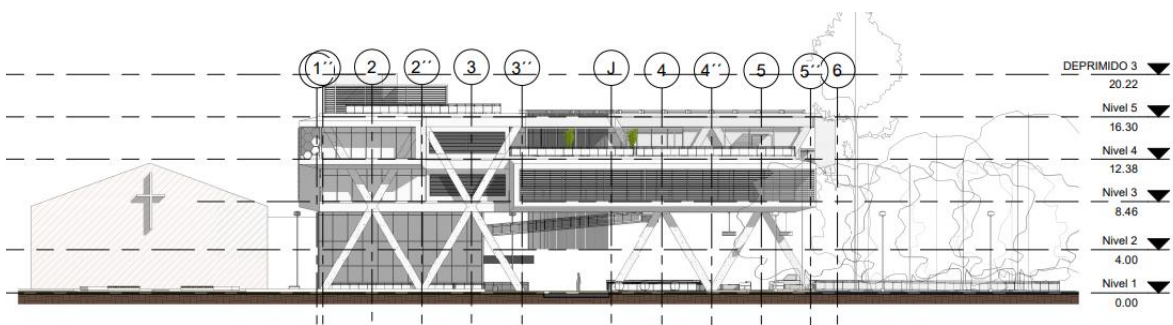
Fachada Oeste proyecto Amar y Avanzar Marsella
